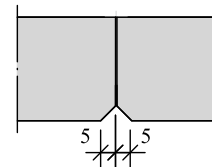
(Draufsicht): Jede CEWOOD Platte 1200x600 wird mit 6 Clips befestigt. Längskantenprofil von Platten - P5H, Stirnkantenprofil - P5.
